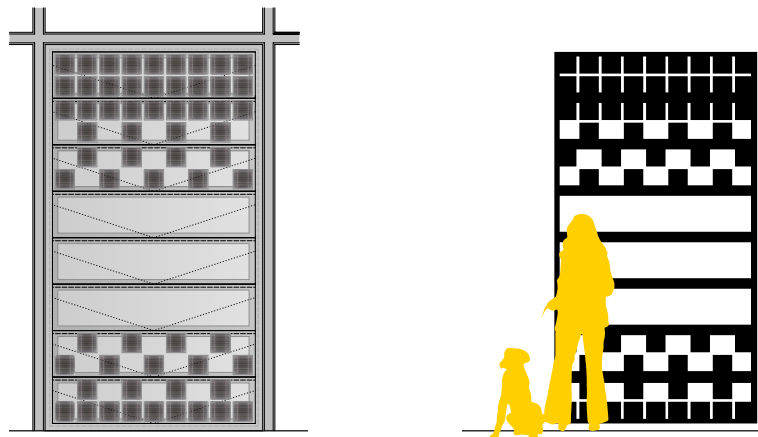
Fassadengestaltung: Ermittlung des Lichtdurchlasses der Fassade
